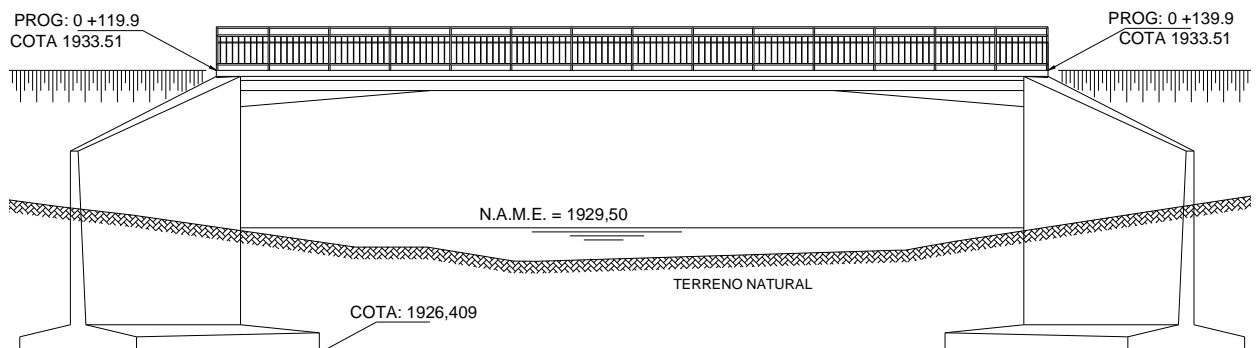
Perfil longitudinal y rasante de accesos.
